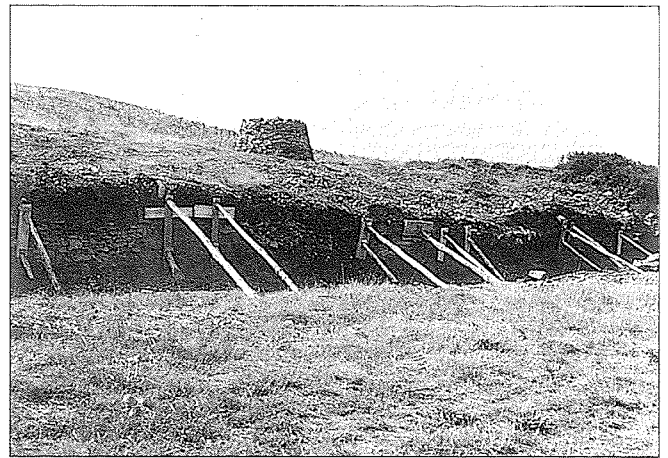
Consolidación y entibado de la muralla norte en el sector excavado.
